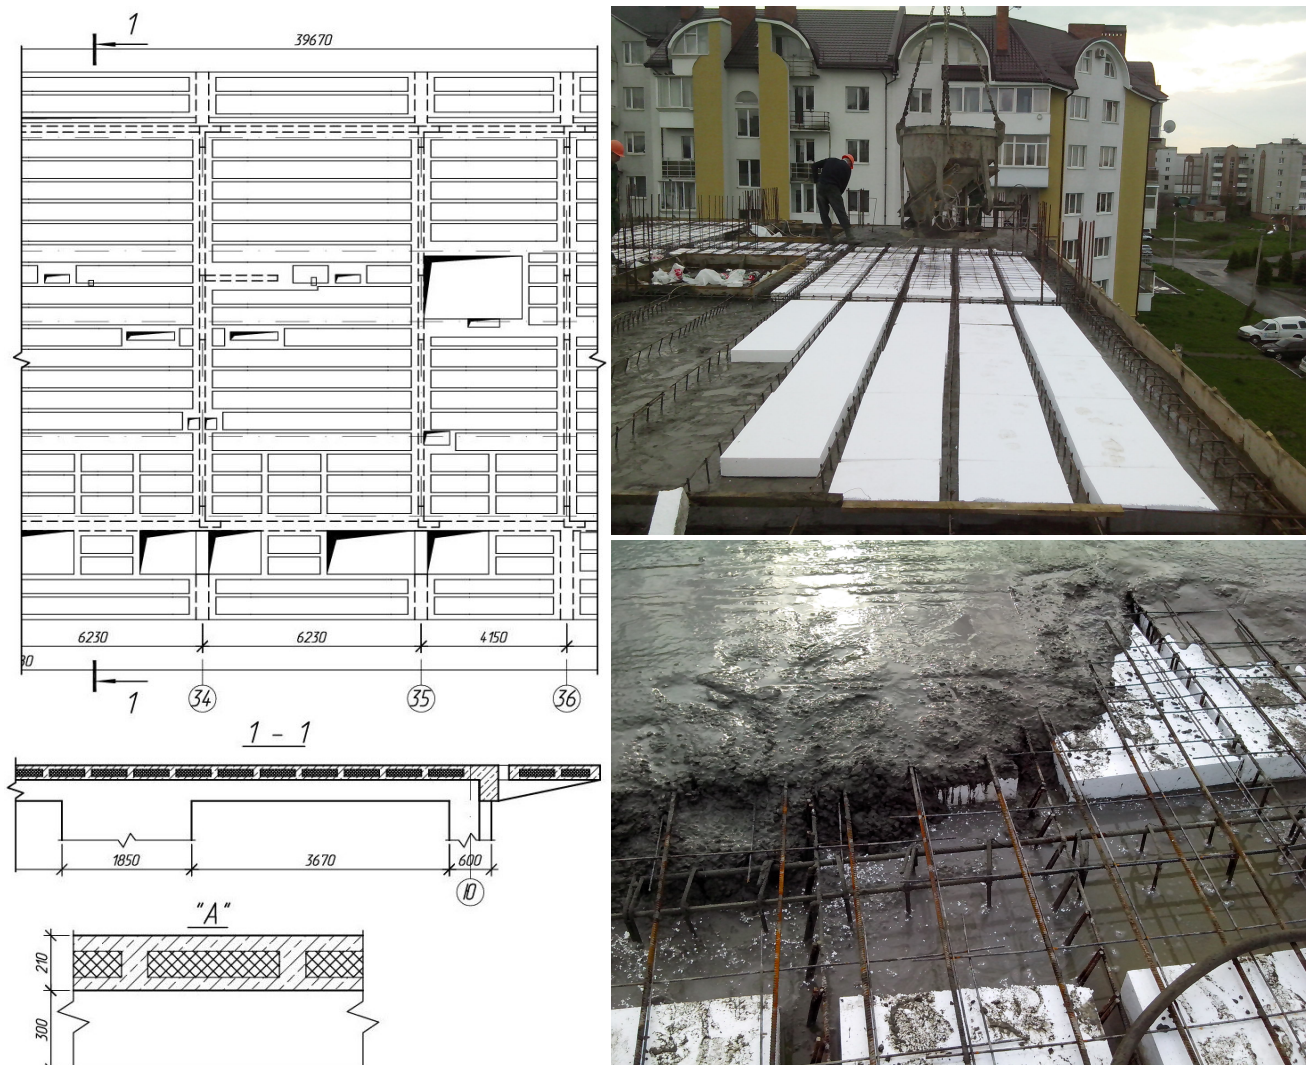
Розташування вставок в плані і в перерізі перекриття будинку №3(а), розкладання вставок і арматурних виробів (б) та бетонування перекриття (в).
